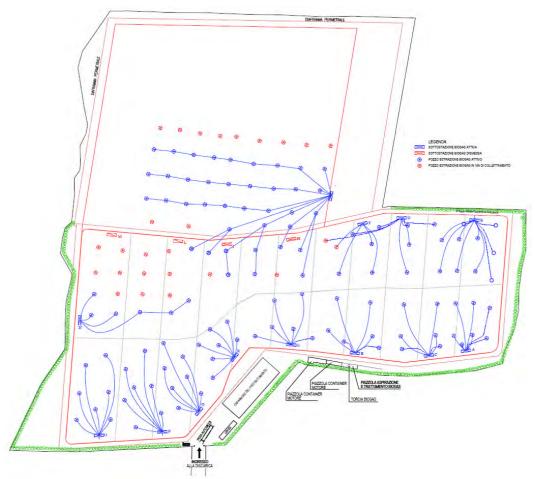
Planimetria stato di fatto impianto di captazione biogas al 30/12/2018
